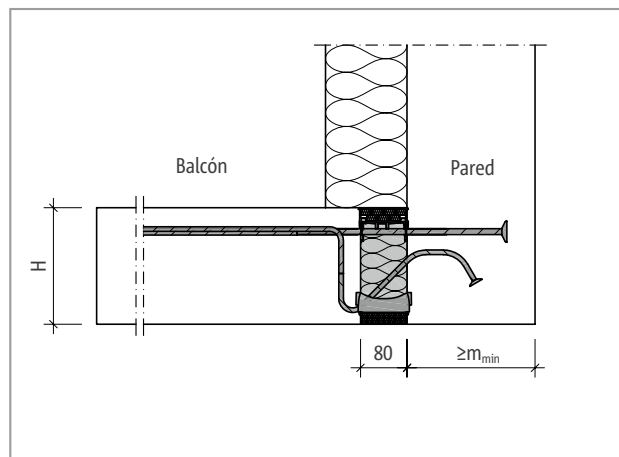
Schöck Isokorb® T tipo K-U: Conexión a pared hacia arriba en caso de aislamiento externo
